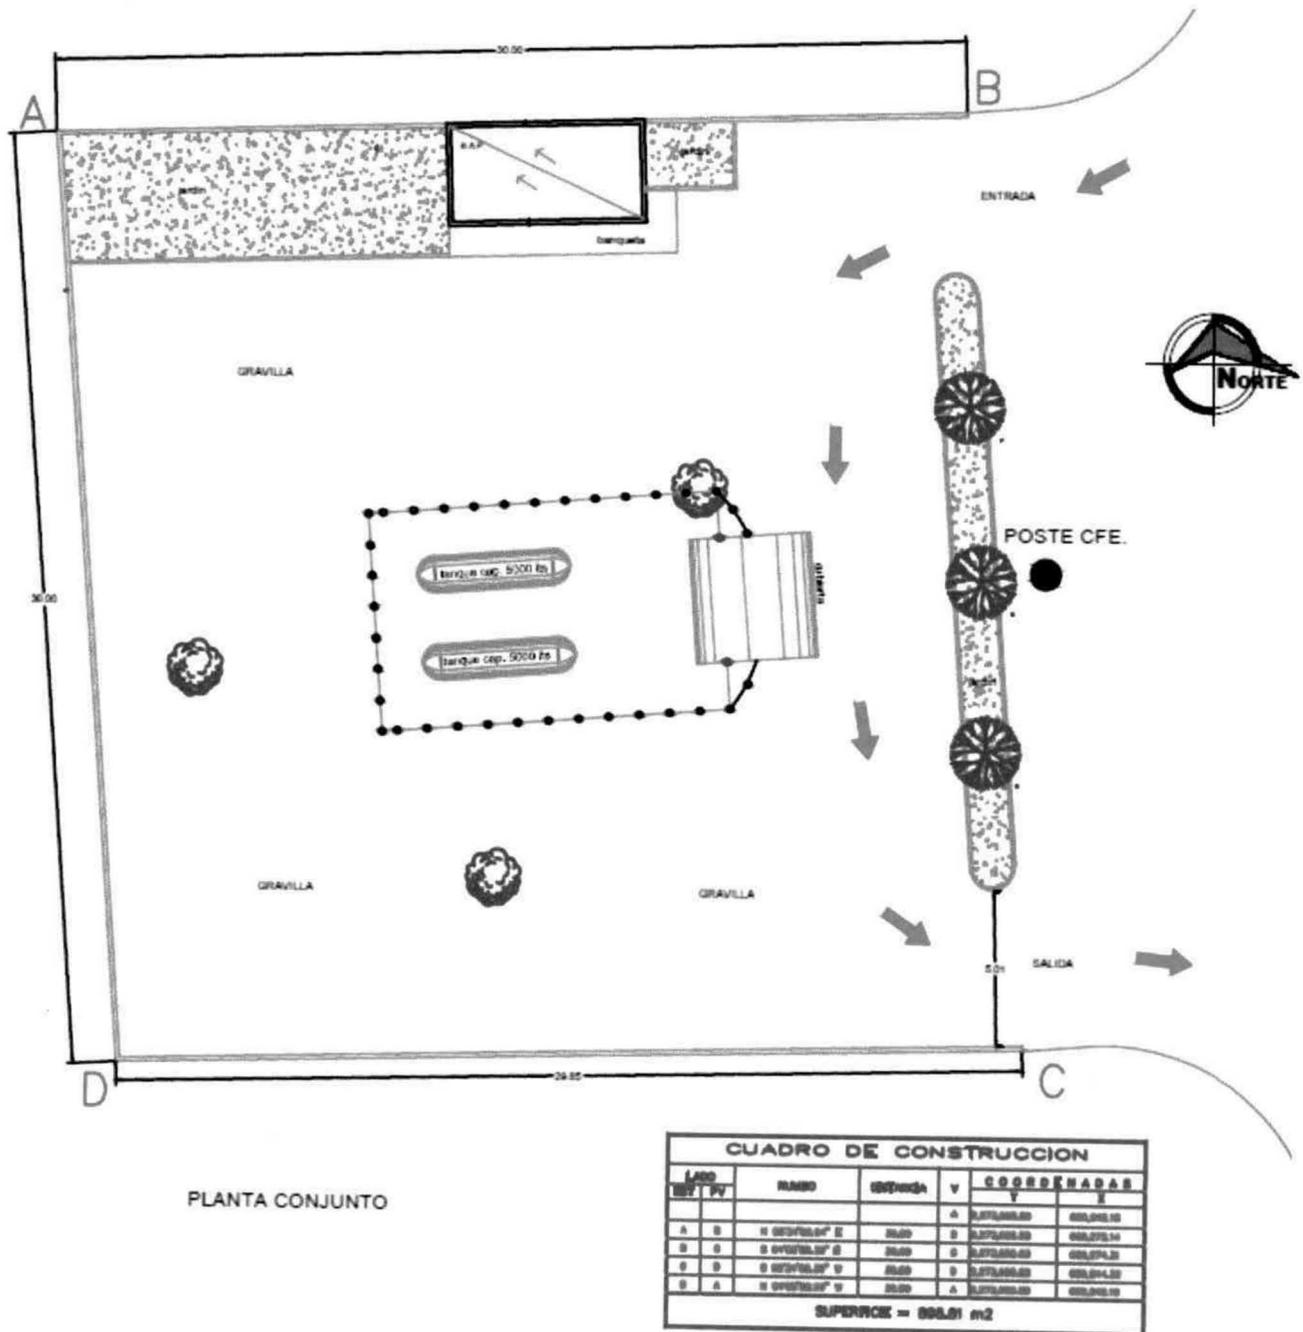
a. Planos de Distribución de áreas y coordenadas.
